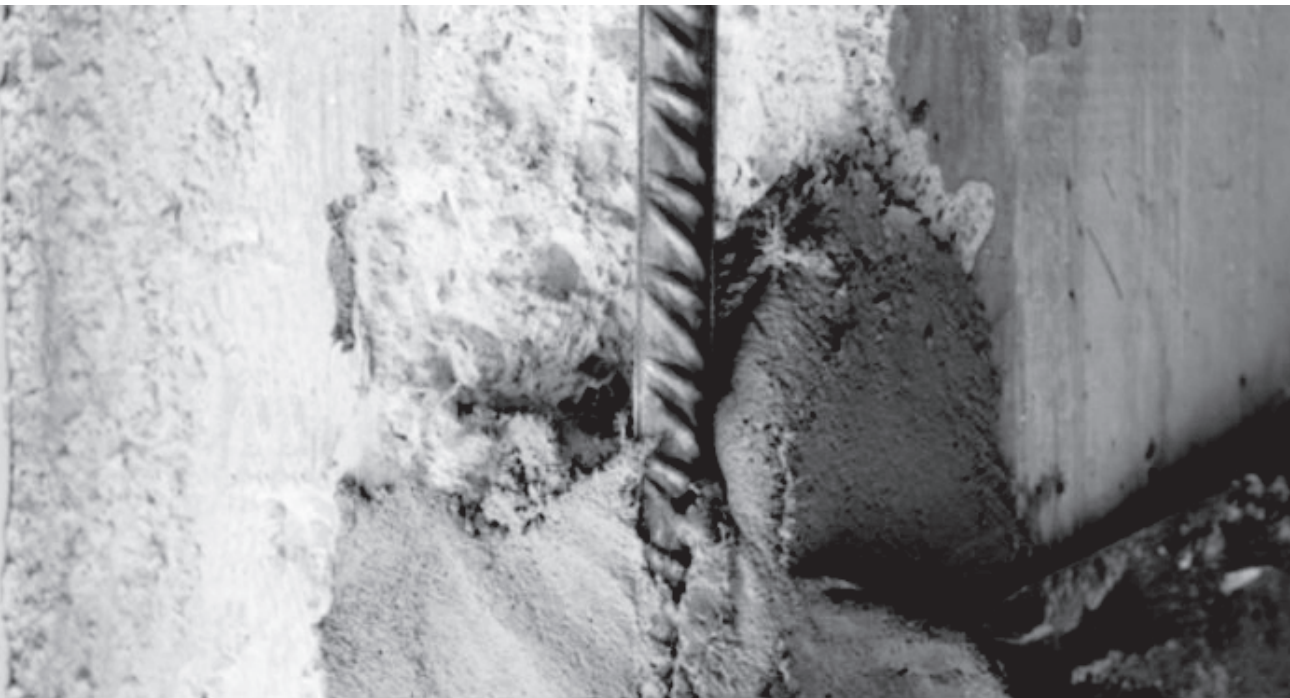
Imagen de empleo de mortero de restitución sobre patología [P.2], corrosión en la armadura de un pilar de hormigón armado.
